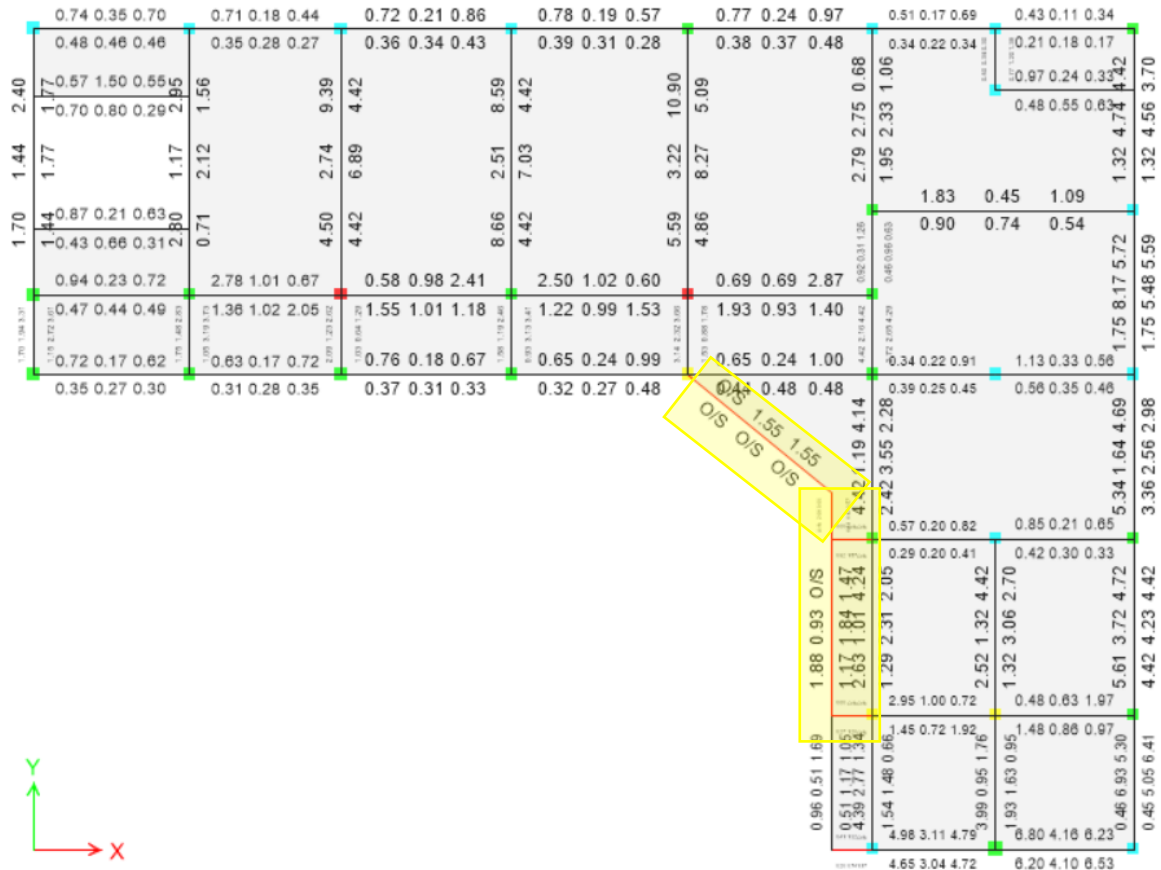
Vista en planta de primer nivel de vigas y columnas del Pabellón A
